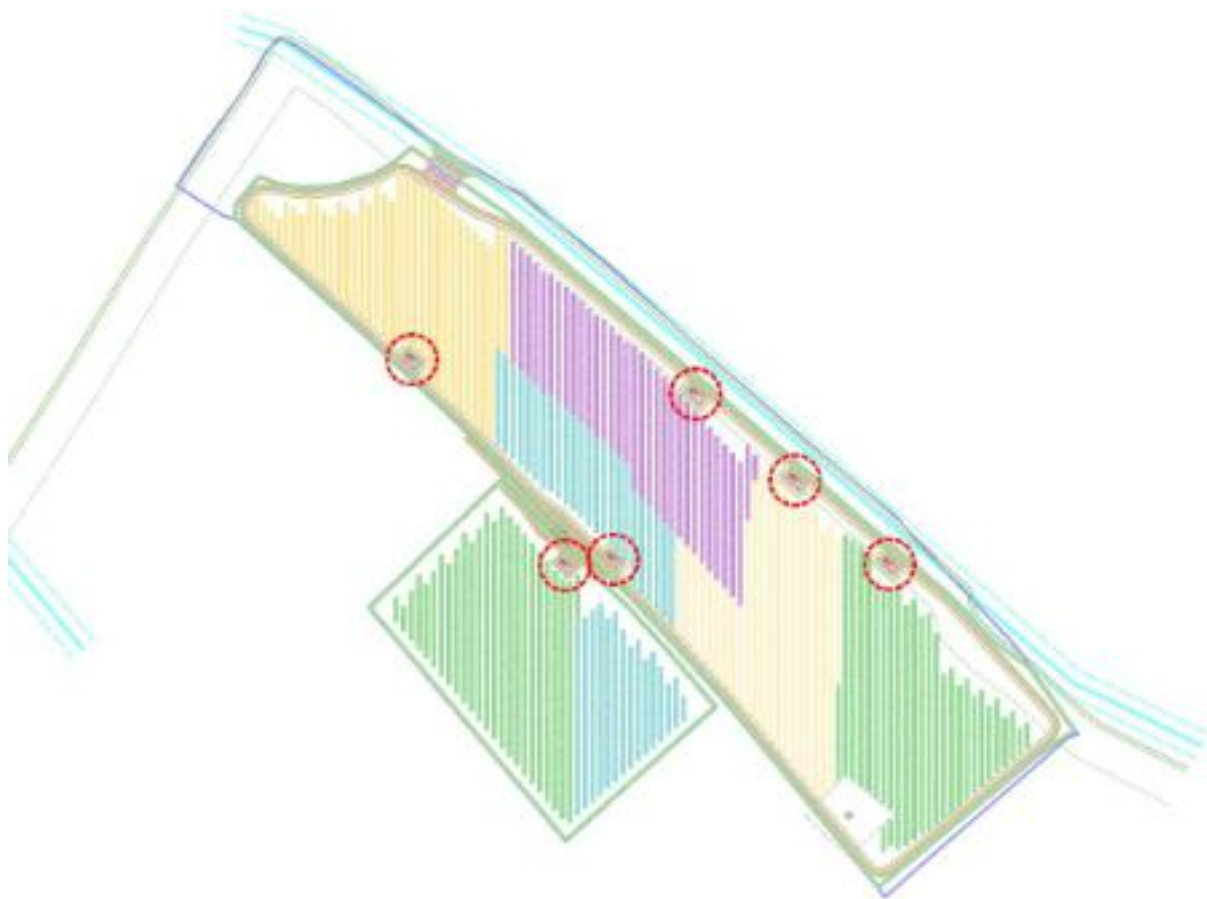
Vista Planimetria dell'impianto FV con evidenza dell'ubicazione delle Cabine di Trasformazione
